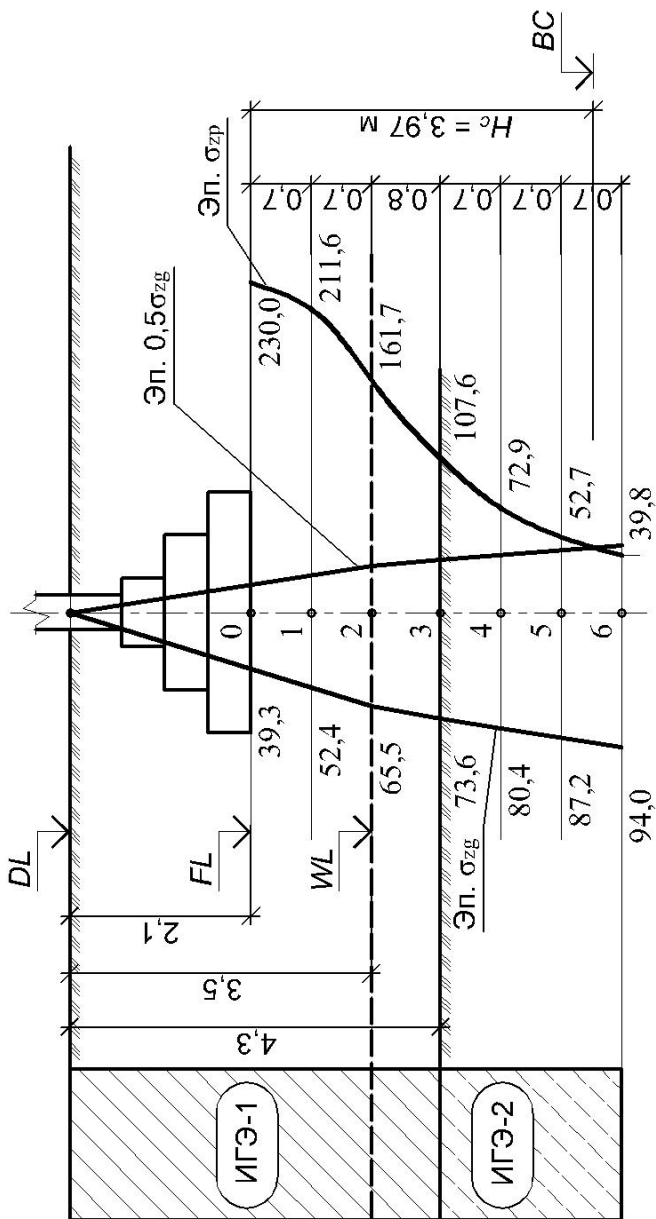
Расчетная схема к определению осадки фундамента методом послойного суммирования (пример 4.6):
